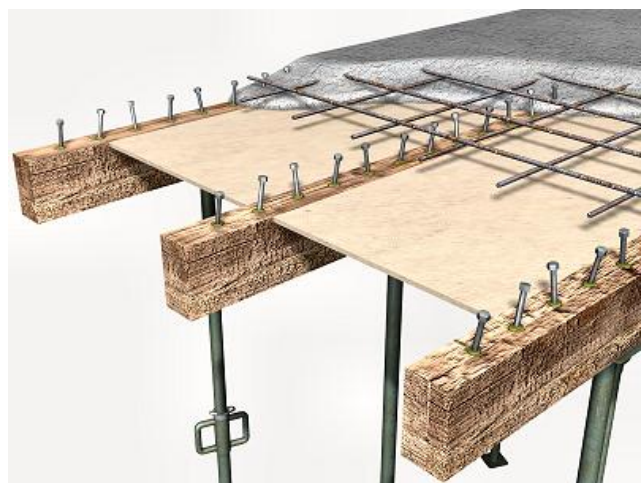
Detalle constructivo refuerzo, Generador de precios Cype
